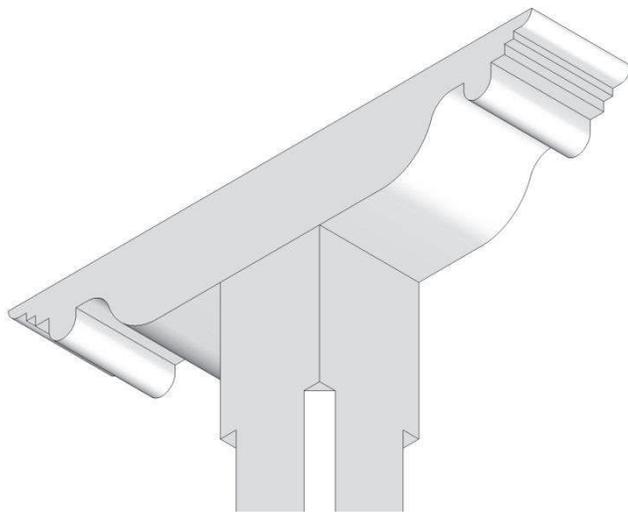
detalle capitel de columna pasillo exterior, Casa Parroquial.
